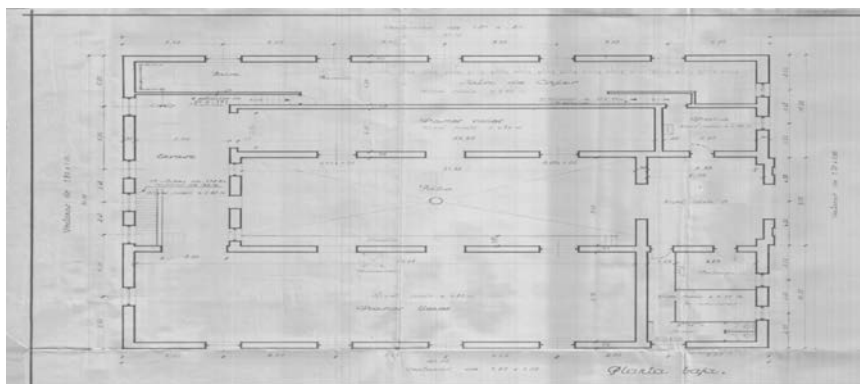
Planta Baja Almacén Azogue; Junio 1942²⁴.
